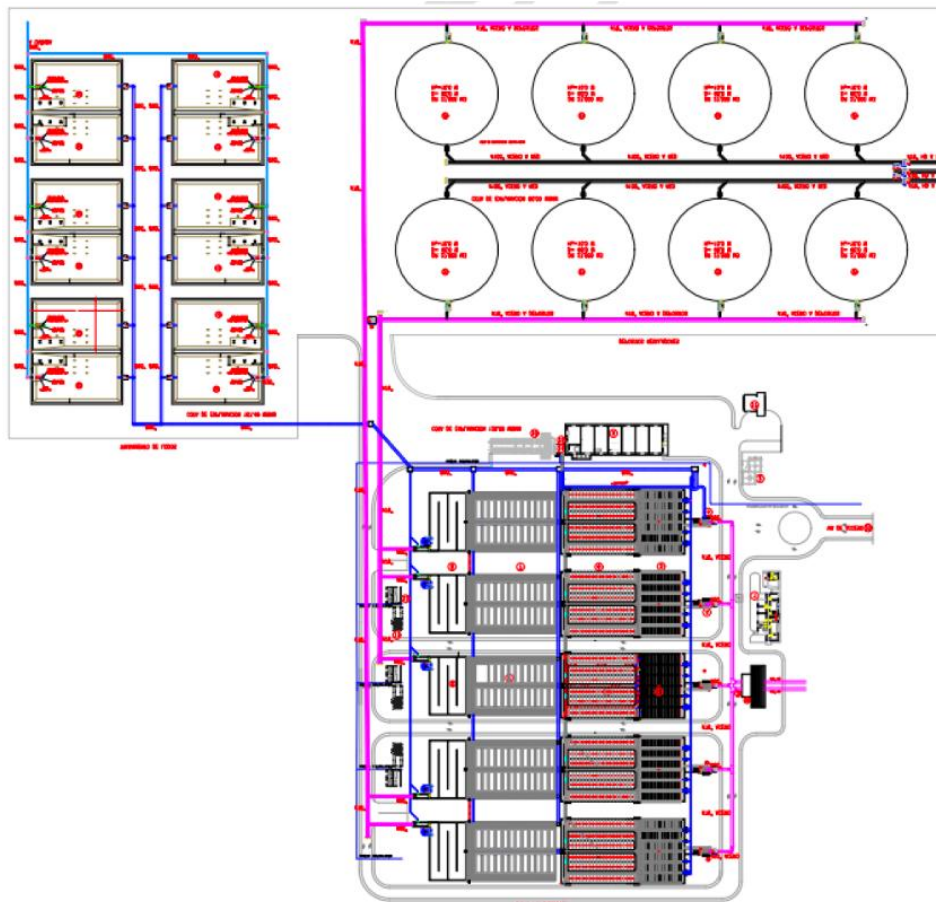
Esquema de la planta de tratamiento estudio CAASD
